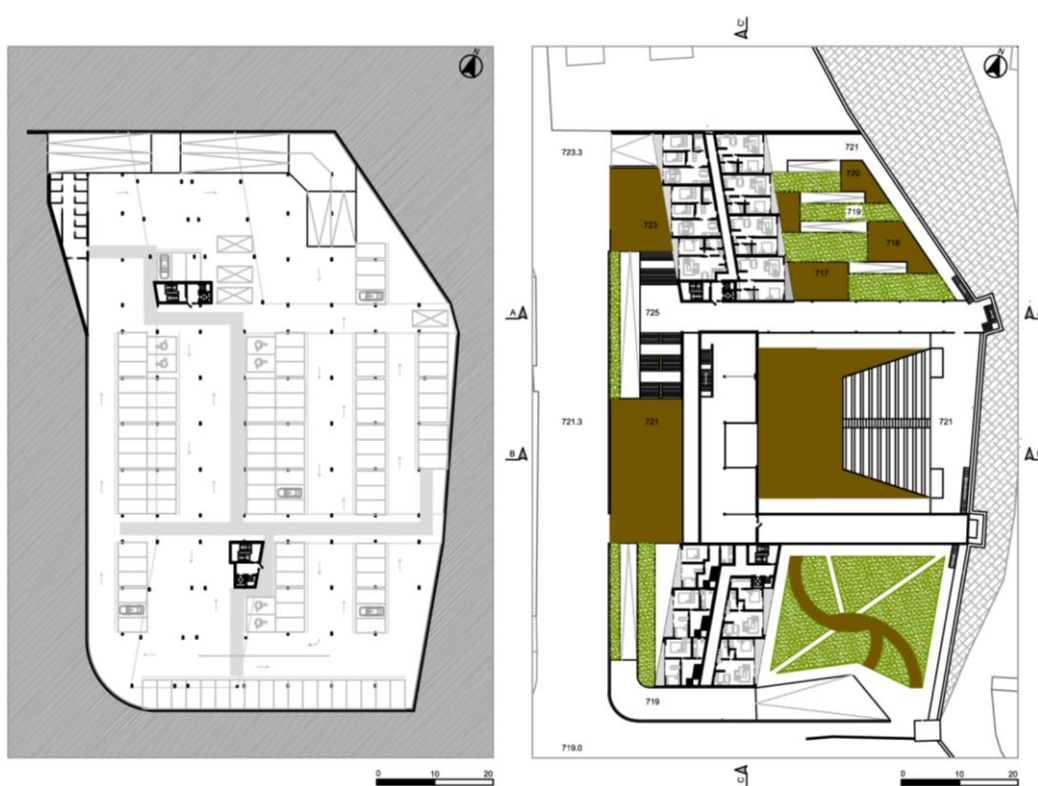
Esq.: Planta piso -1; Dir.: Planta piso 2
